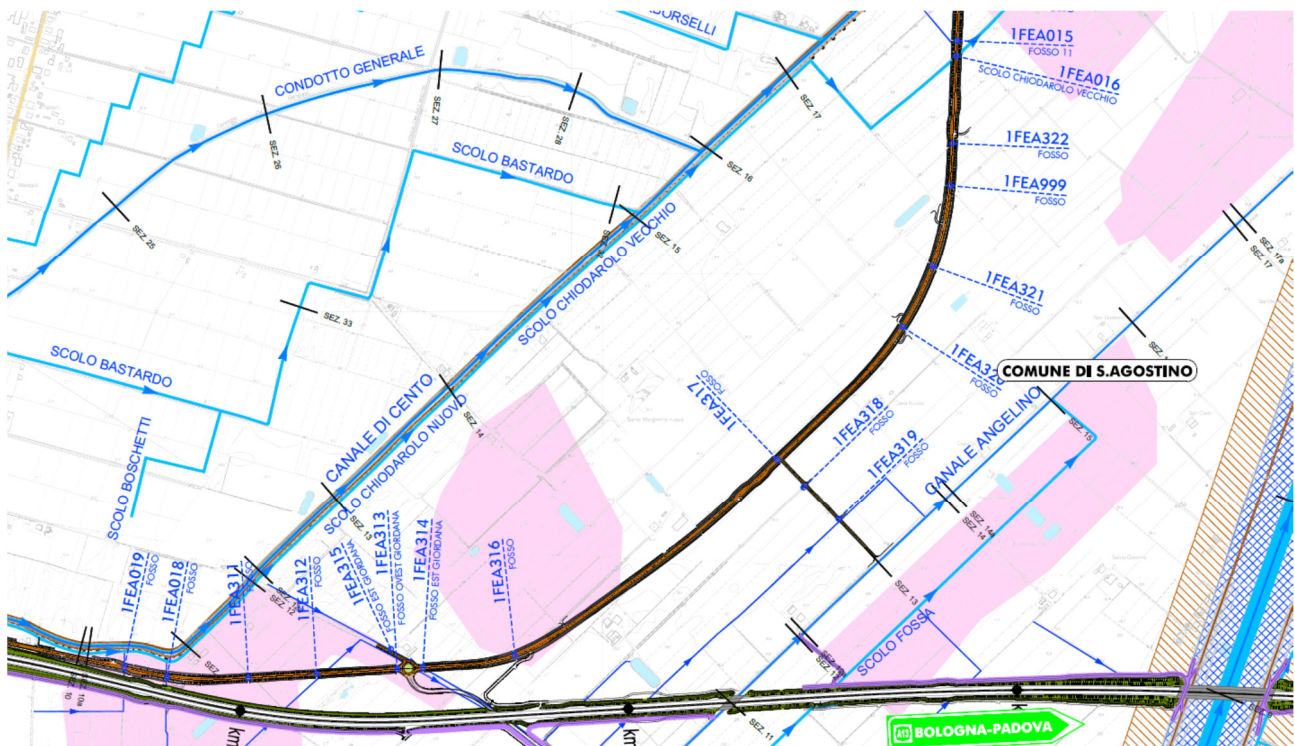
AREE STORICAMENTE ALLAGATE
